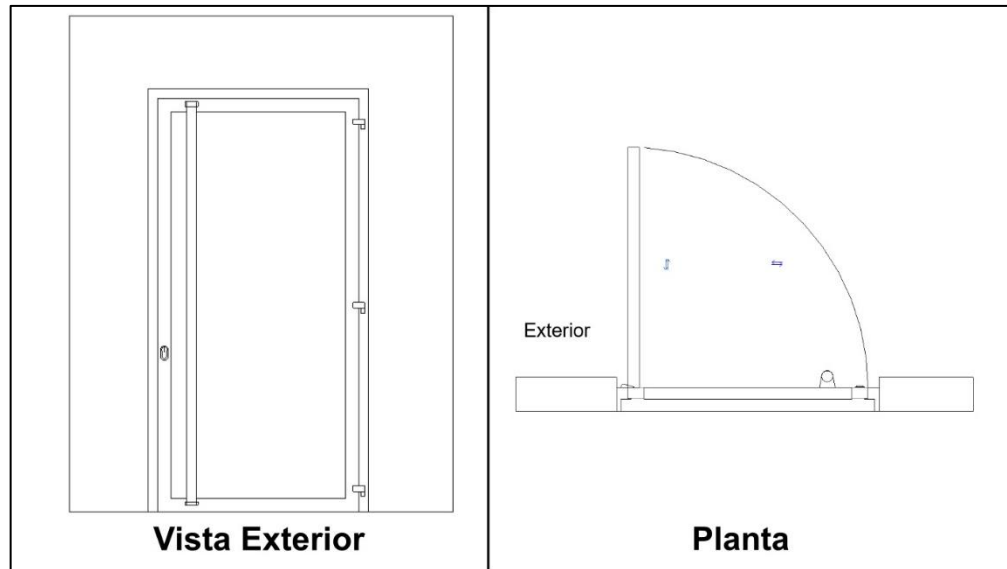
Vista exterior e em planta da porta exterior, no Revit®.
